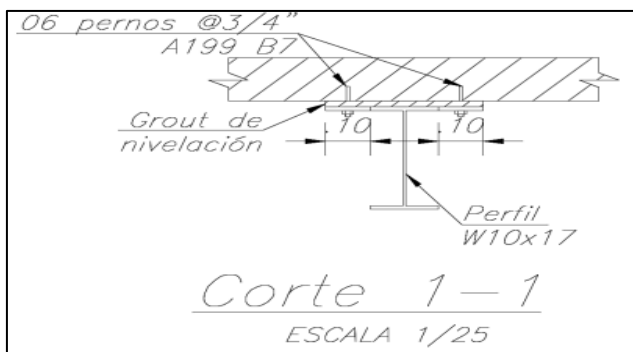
Esquemas de reforzamiento con Vigas metálicas, por debajo de la losa
